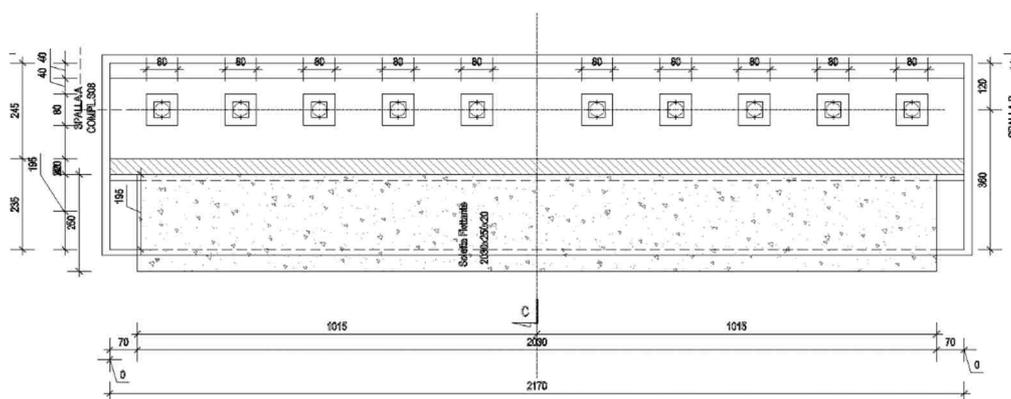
Spalla A pianta -- Viadotto Cungianus
